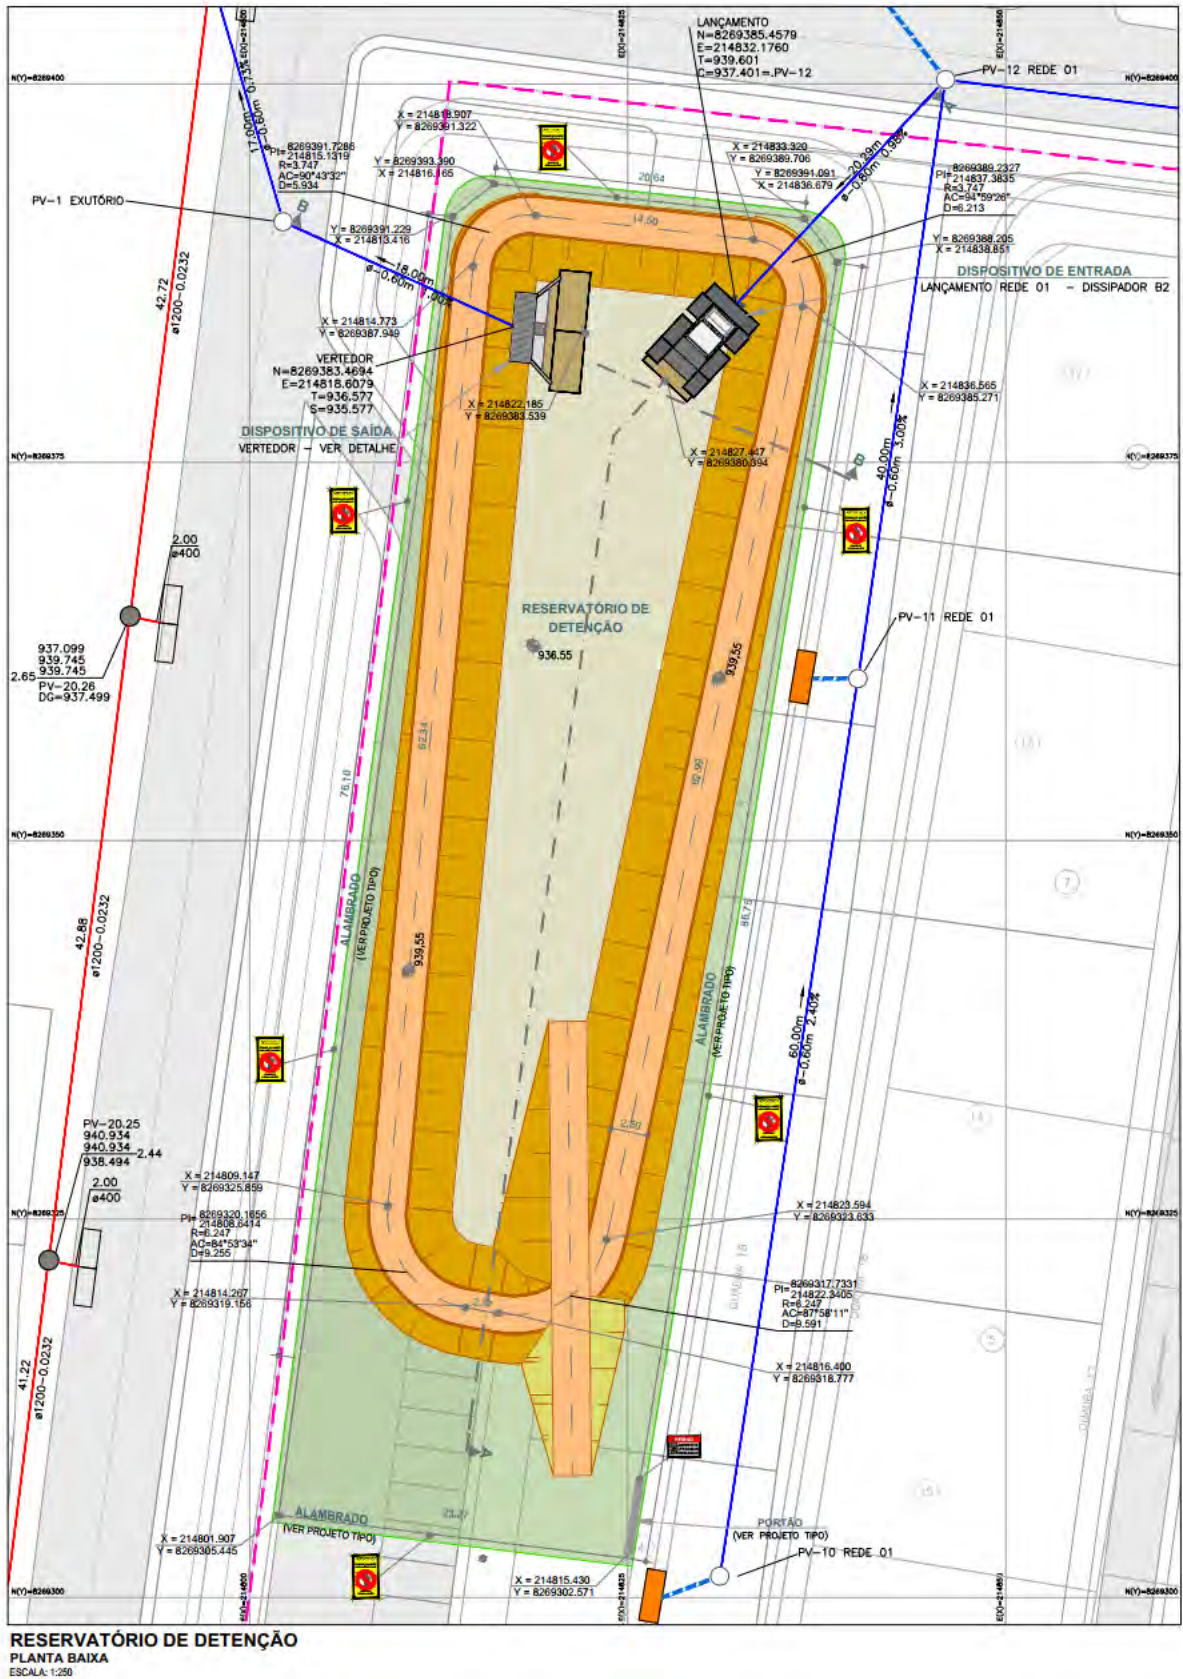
Recorte da planta do reservatório de detenção e lançamento na rede da NOVACAP. Fone: Autor.
